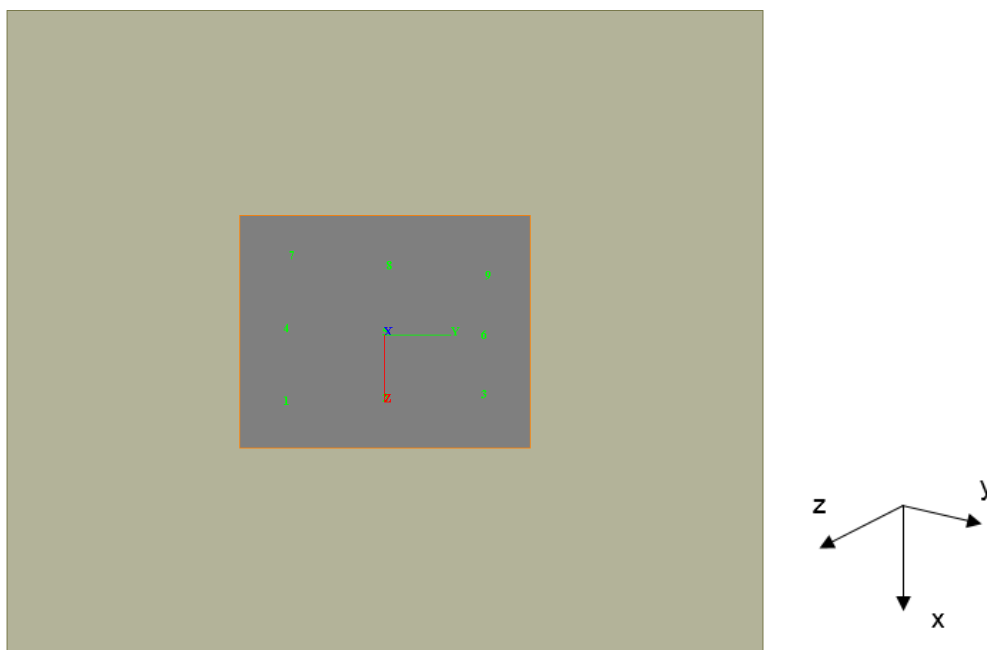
Spalla B: Pianta della palificata e sistema di riferimento utilizzato nel software GROUP2016.
